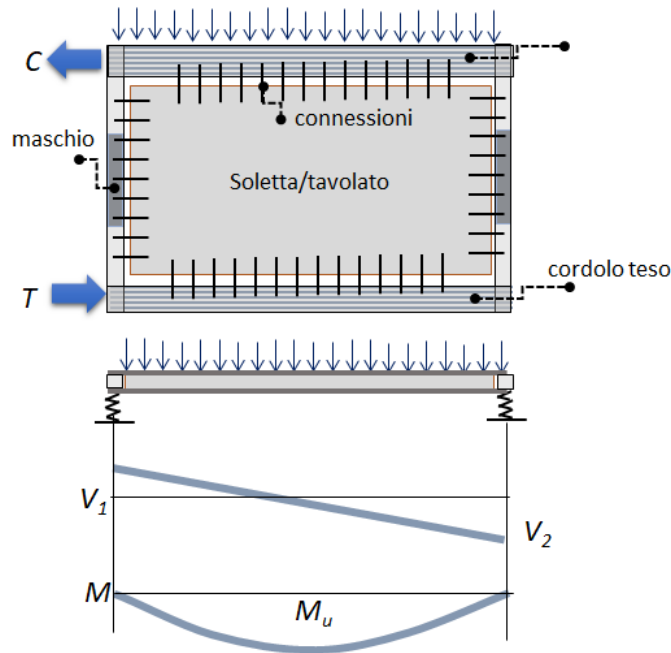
Schematizzazione del sistema di trasferimento delle azioni del solaio alle pareti
